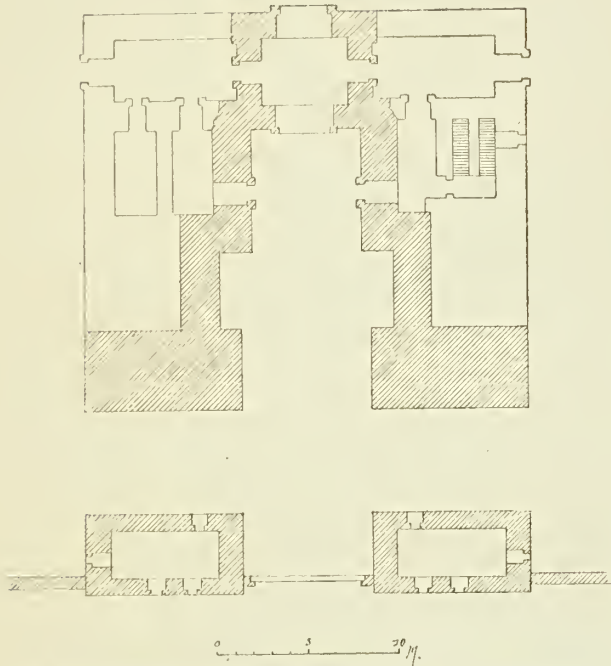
PLANTA BAJA DEL PABELLÓN REAL DE MEDINET-ABU
